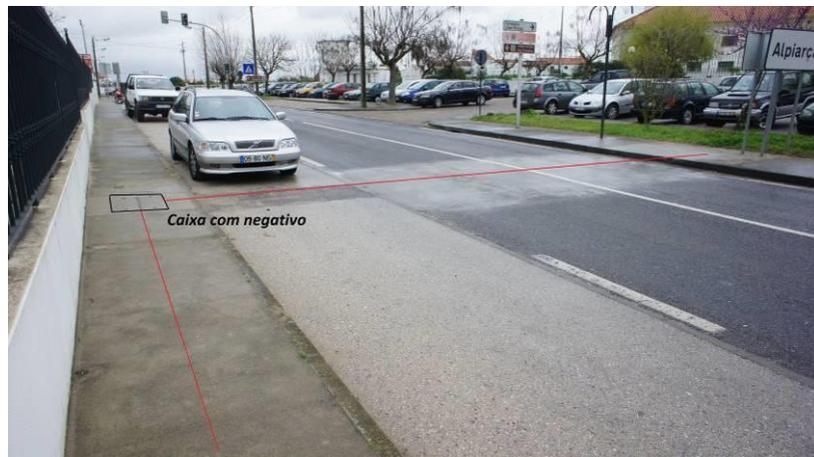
Pré-instalação de Infraestruturas para Fibra Ótica
